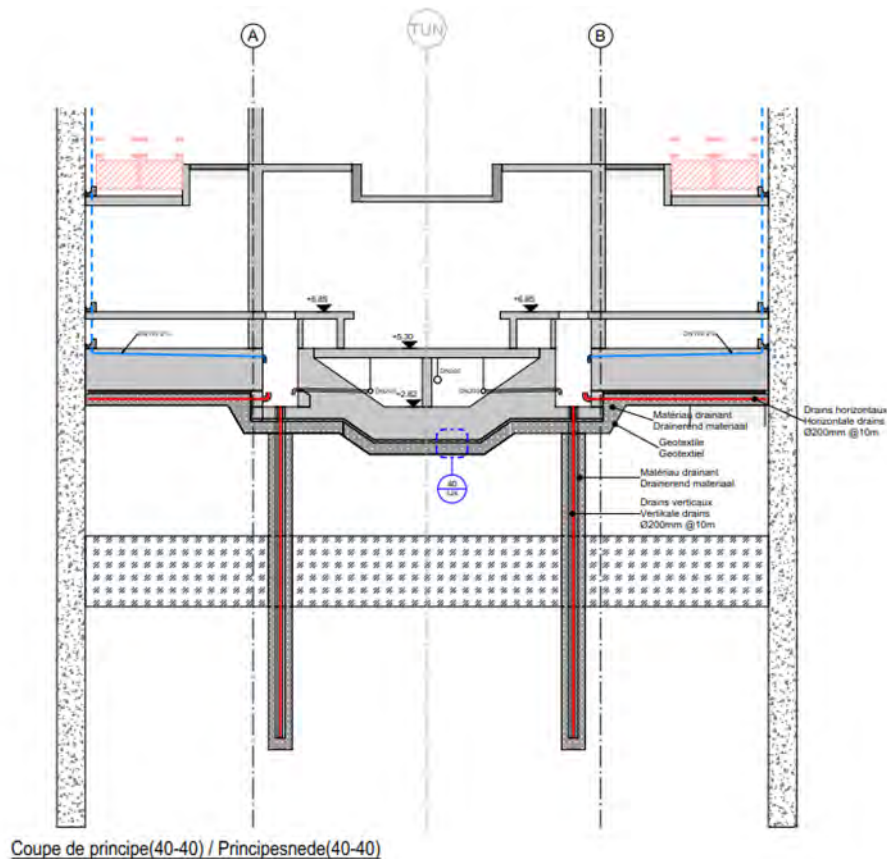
Exemple de coupe transversale – base de la boîte et système de drainage (BMN, 2020)
